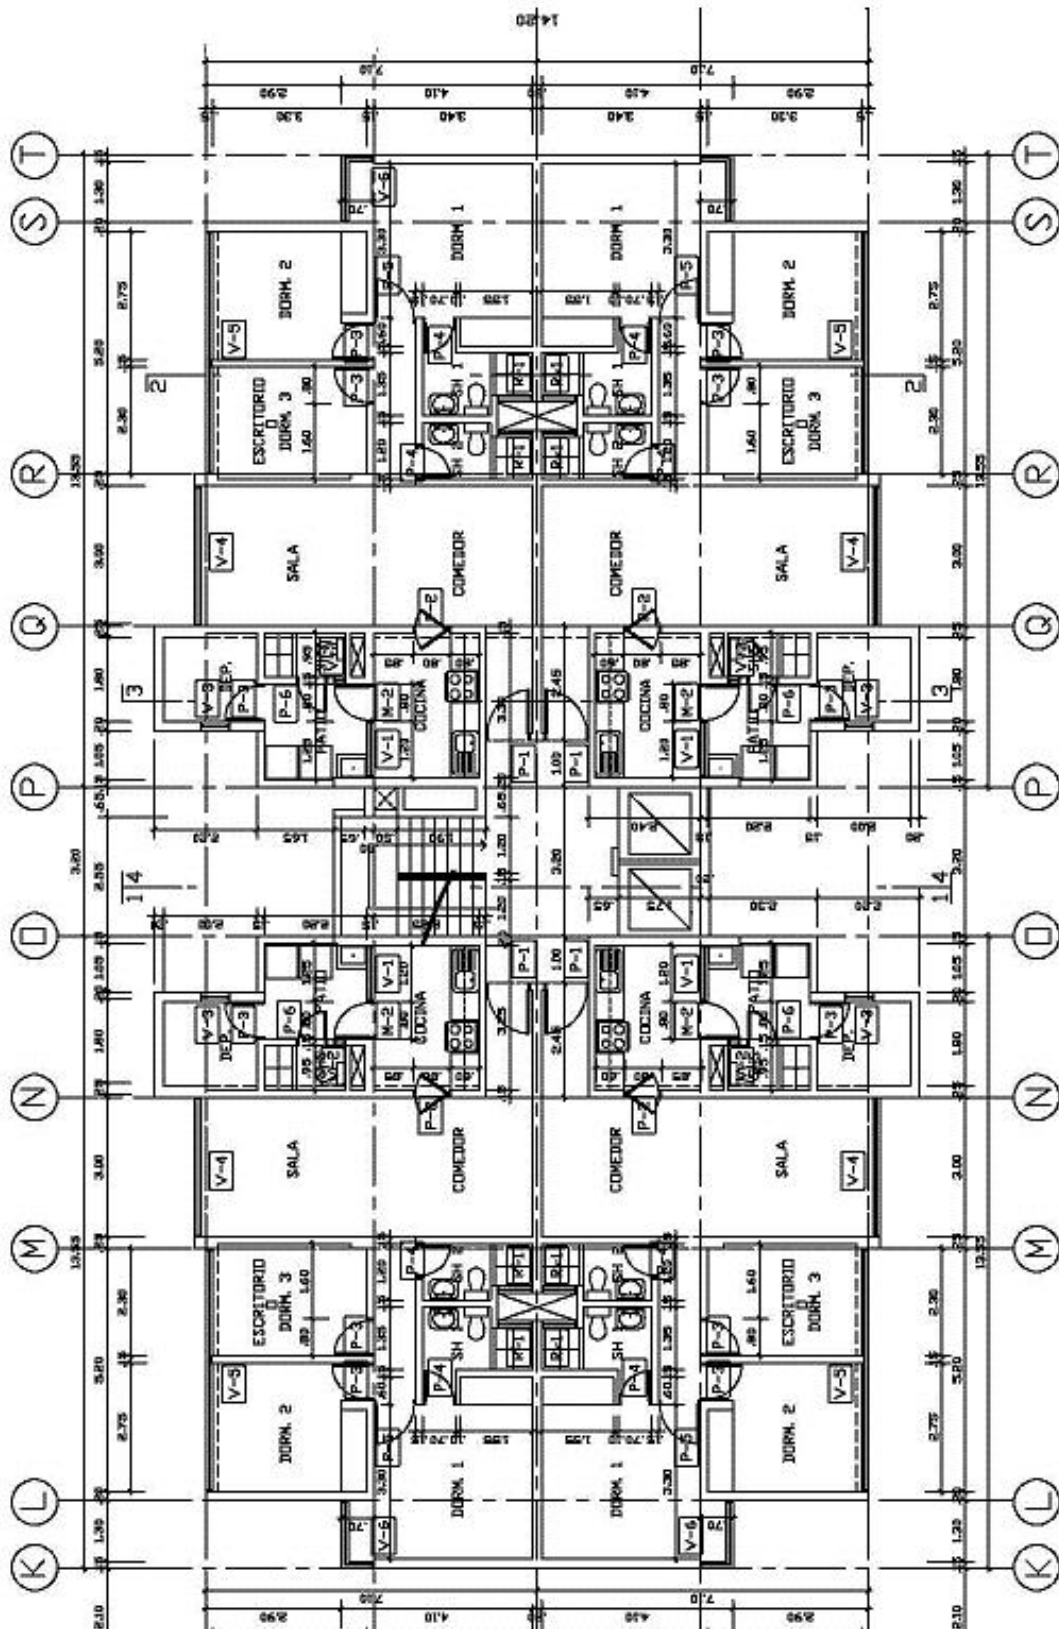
Planta Típica de Torres Gemelas de 12 Pisos
